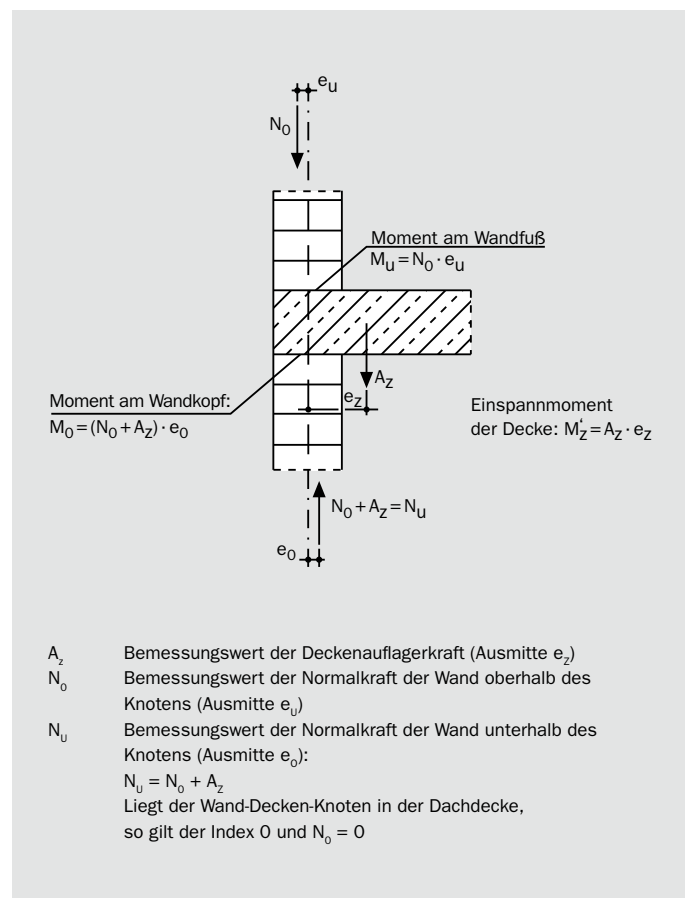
/4: Bezeichnung der Schnittgrößen des Wand-Decken-Knotens
